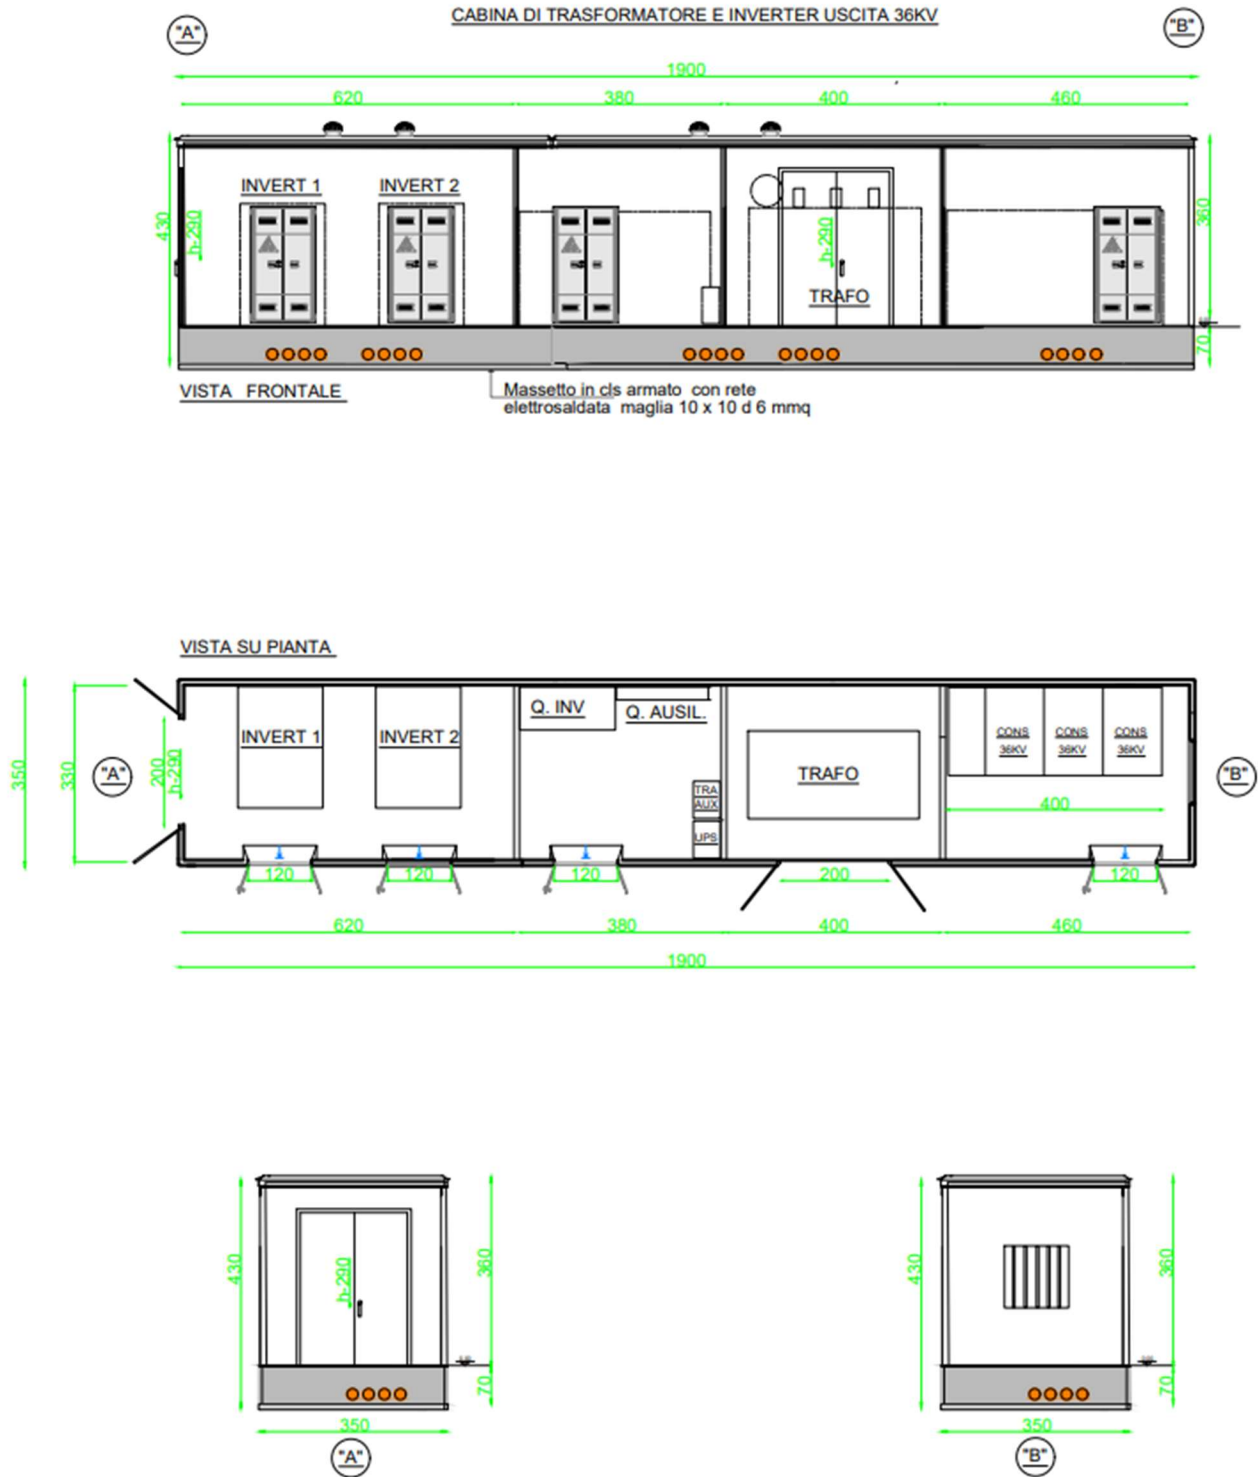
Planimetria e prospetti dell'unità di trasformazione
